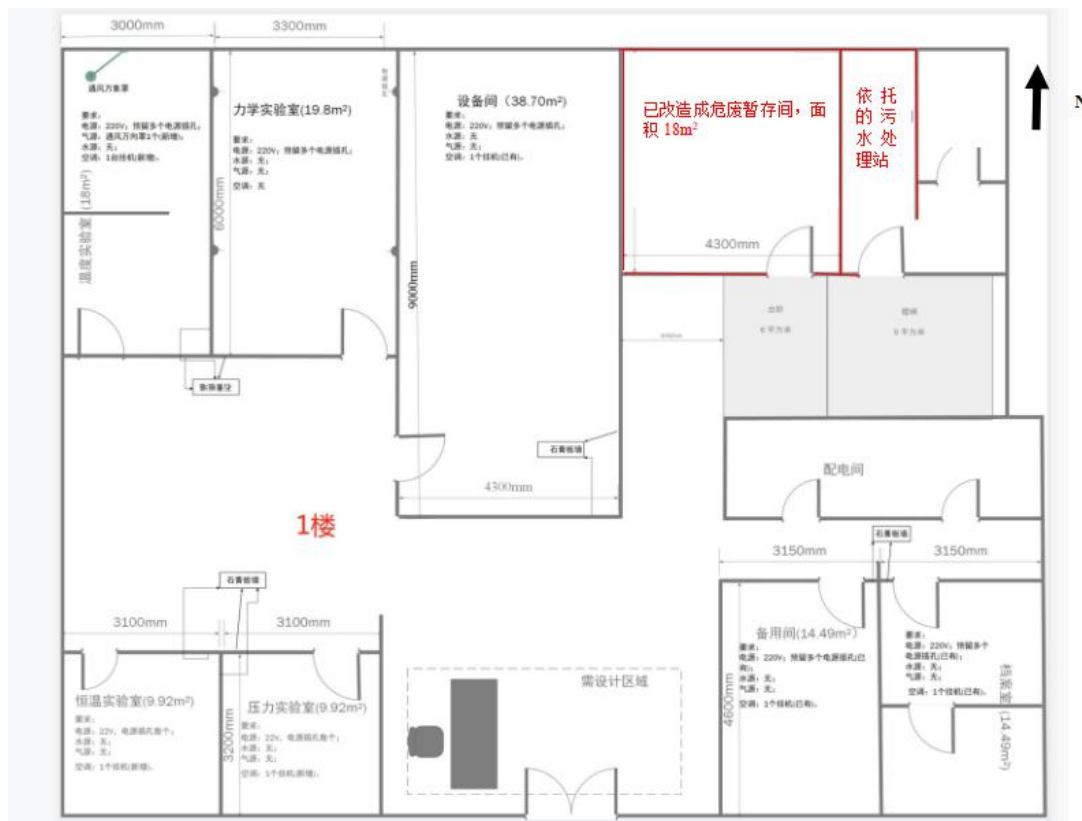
安徽新力电业高技术有限责任公司厂房1楼平面布置示意图
